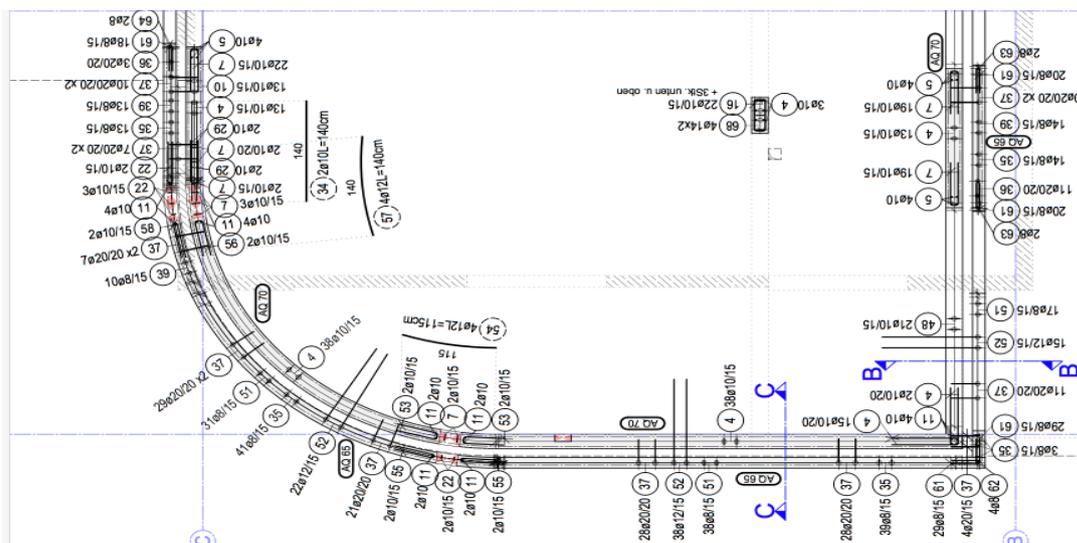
Bewehrungsplan Grundriss der Fassade 8
